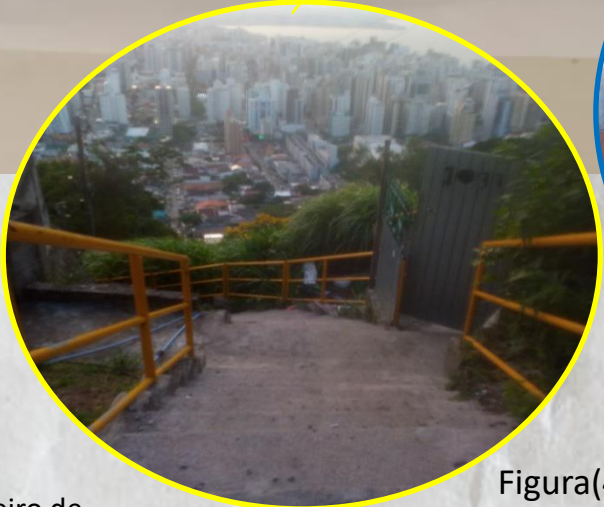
Principal eixo de conexão entre a Av. Mauro ramos e a Rua General Viera da Rosa e circulação de pedestre. Fonte: Acervo pessoal
